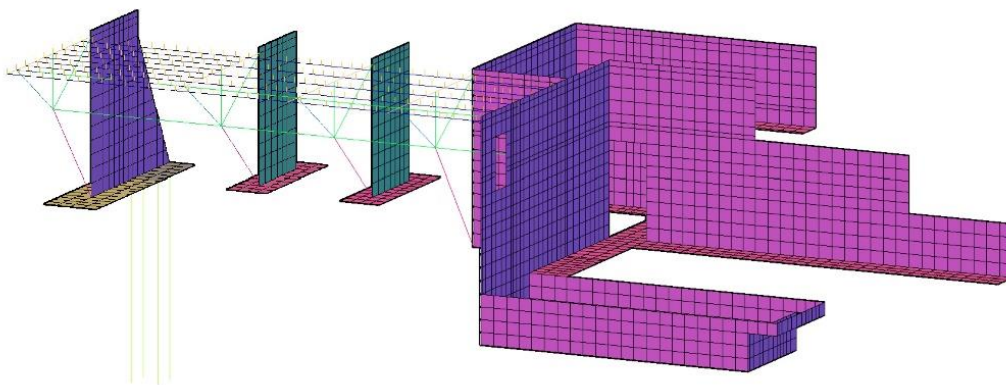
Geometría del modelo en AutoCAD. Cimbra unida a la geometría de la vivienda. Fuente: elaboración propia.
